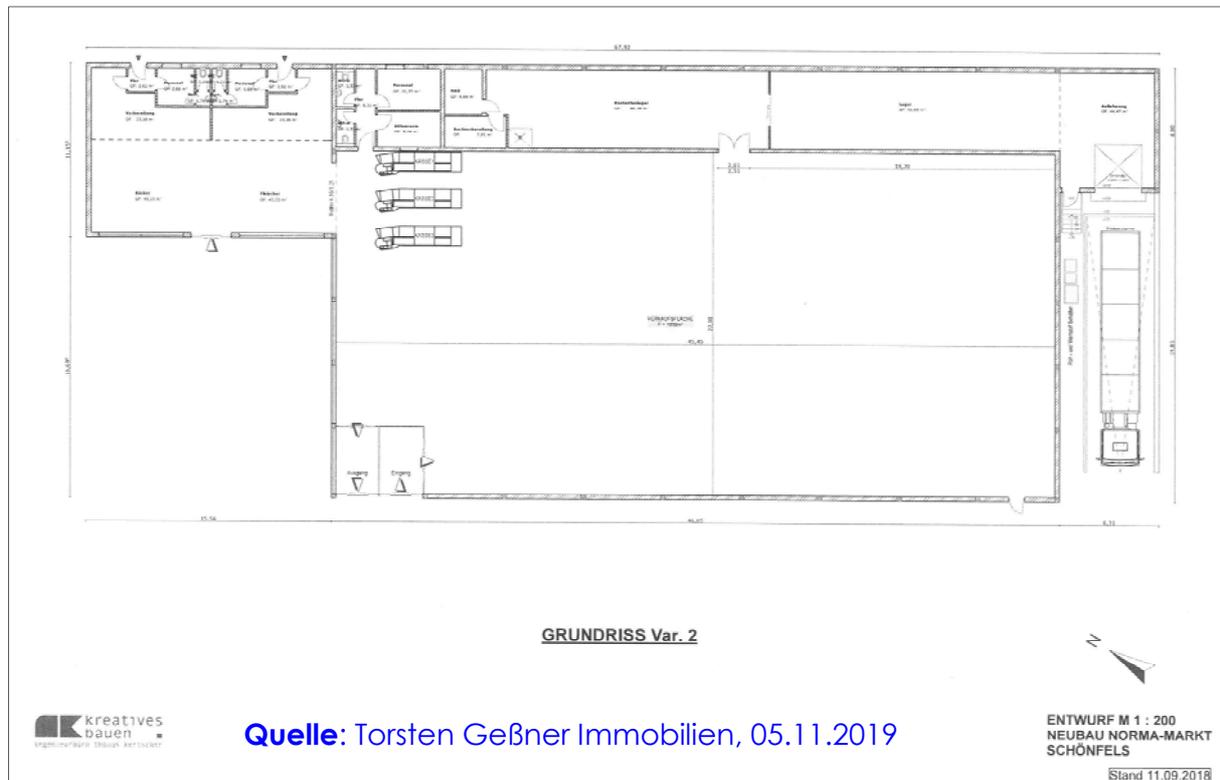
Grundriss Bauvorhaben NORMA-Markt Schönfeld mit Bäcker und Fleischer
